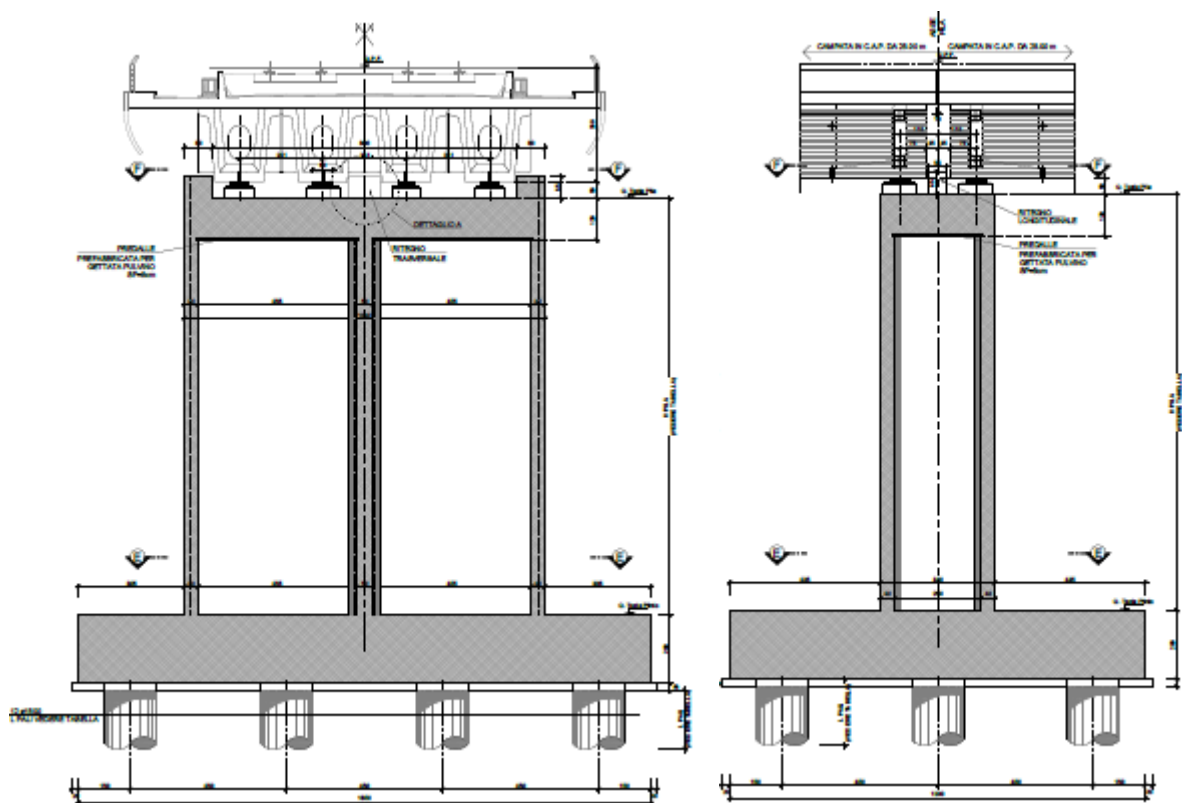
Sezione in direzione trasversale e longitudinale rispetto all'asse del viadotto
